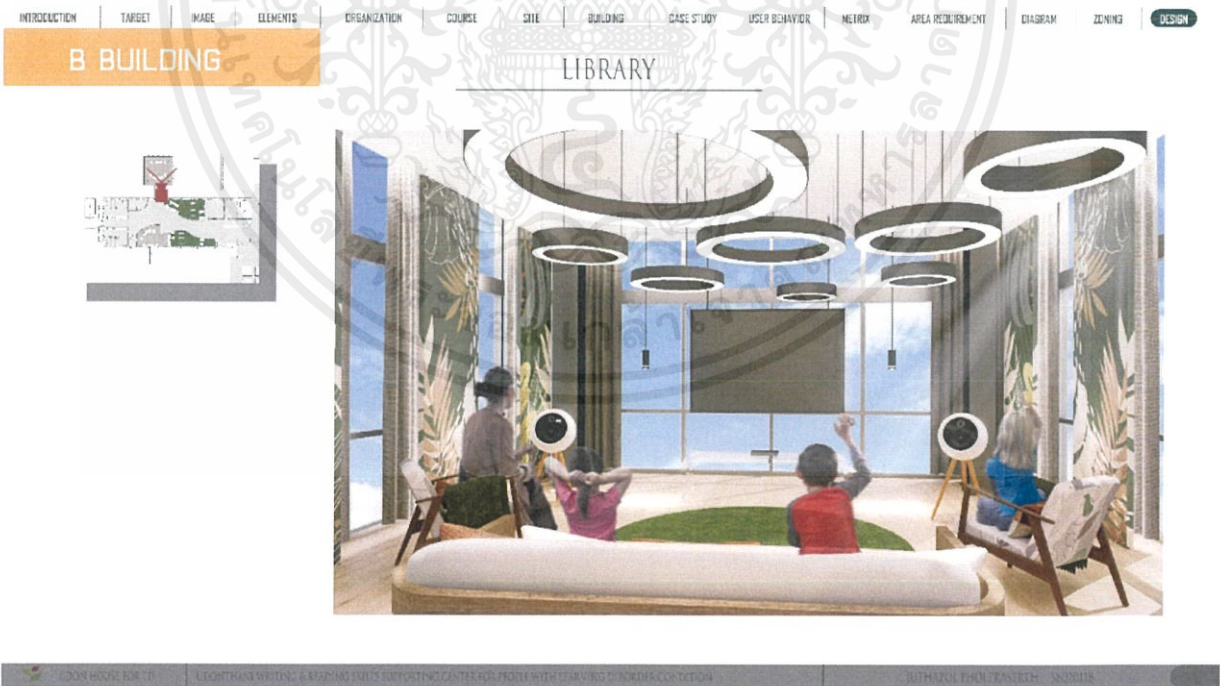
8 B BUILDING LIBRARY
